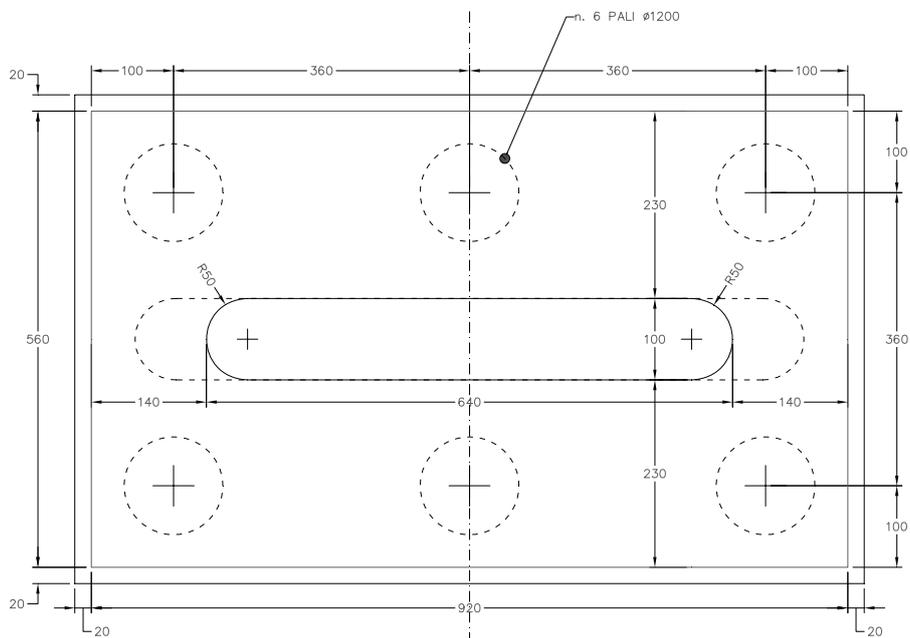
Pianta della zattera e sezione del fusto della pila
